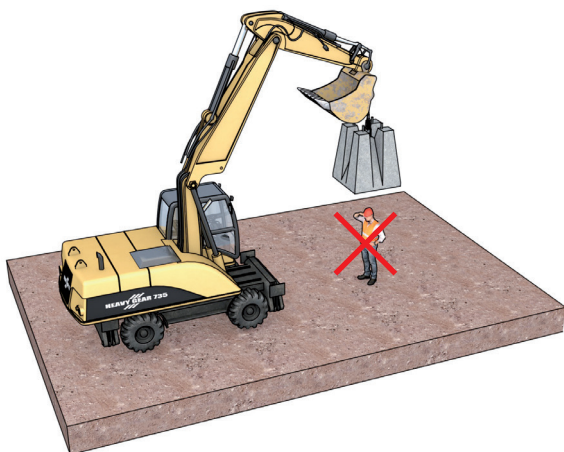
Exemple d'implantation d'anneau de levage sur massif
